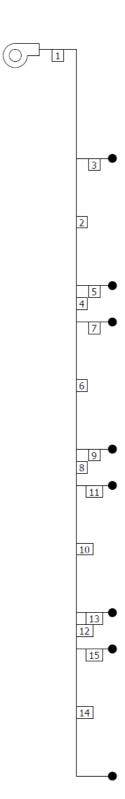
Distribución ramales Planta Baja CL N-S
